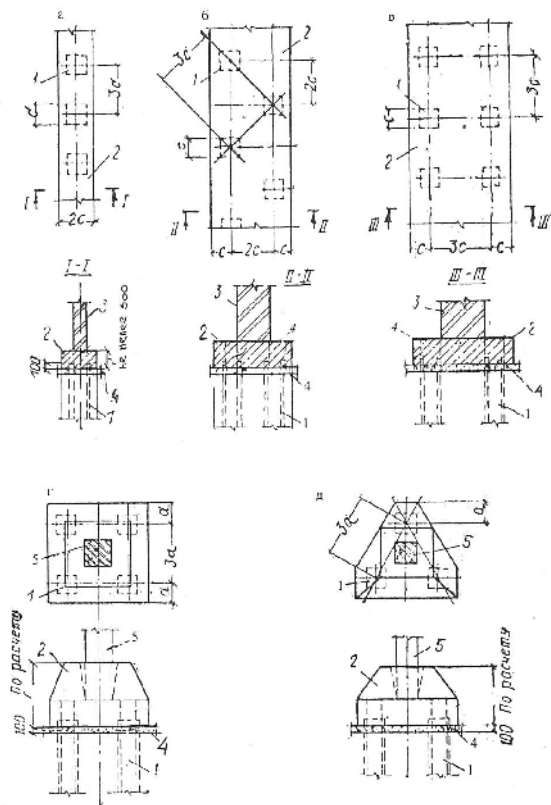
Схемы расстановки свай под фундаментами: а – однорядная; б – шахматная; в – двухрядная; г, д – варианты свайного фундамента под колонну; 1 – свая; 2 – монолитный ростверк; 3 – стена здания; 4 – железобетонная или бетонная подготовка; 5 – колонна
